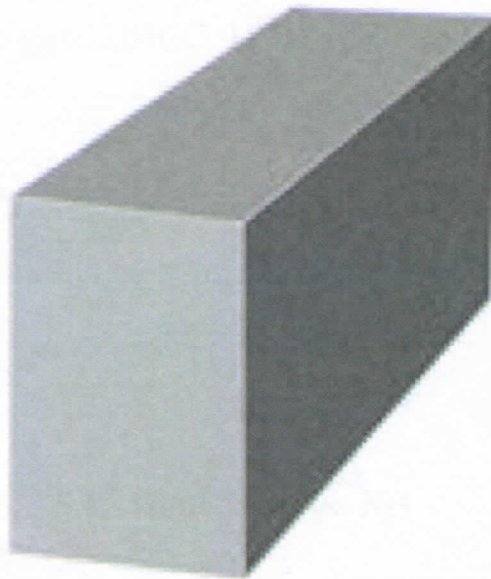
Газобетонный блок, использованный для возведения ненесущих стен
